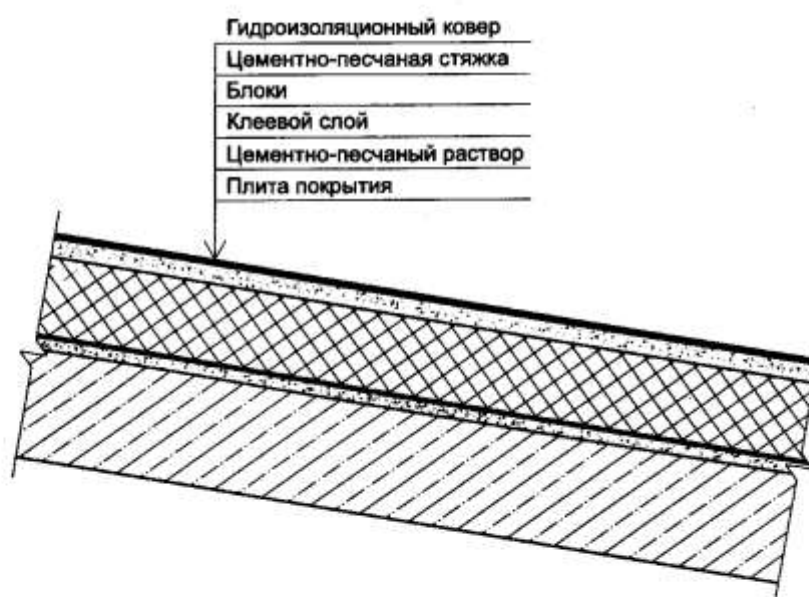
Тепловая изоляция совмещенной плоской кровли из блоков
